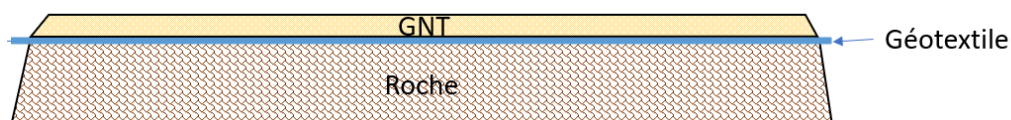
Construction des pistes lourdes (Source : Sun Agri)
